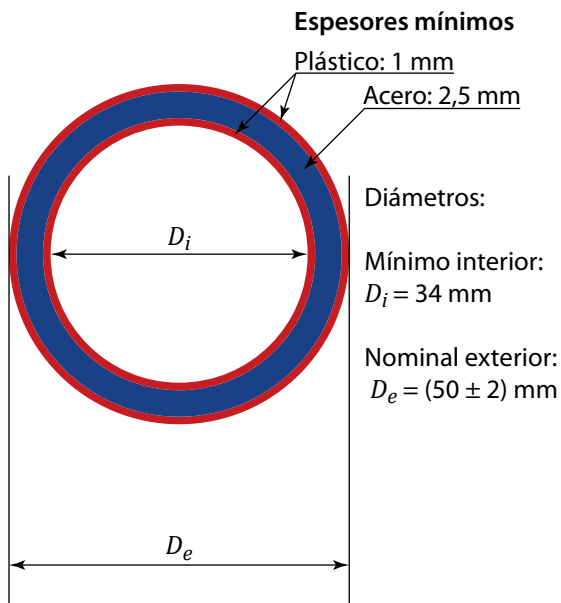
Caño aislado para pilar de conexión eléctrica domiciliaria (caño compuesto). Vista de la sección transversal (escala 1:1, aproximadamente). [Referencia: Norma IRAM 2477, esquema A2, octubre 2017]
